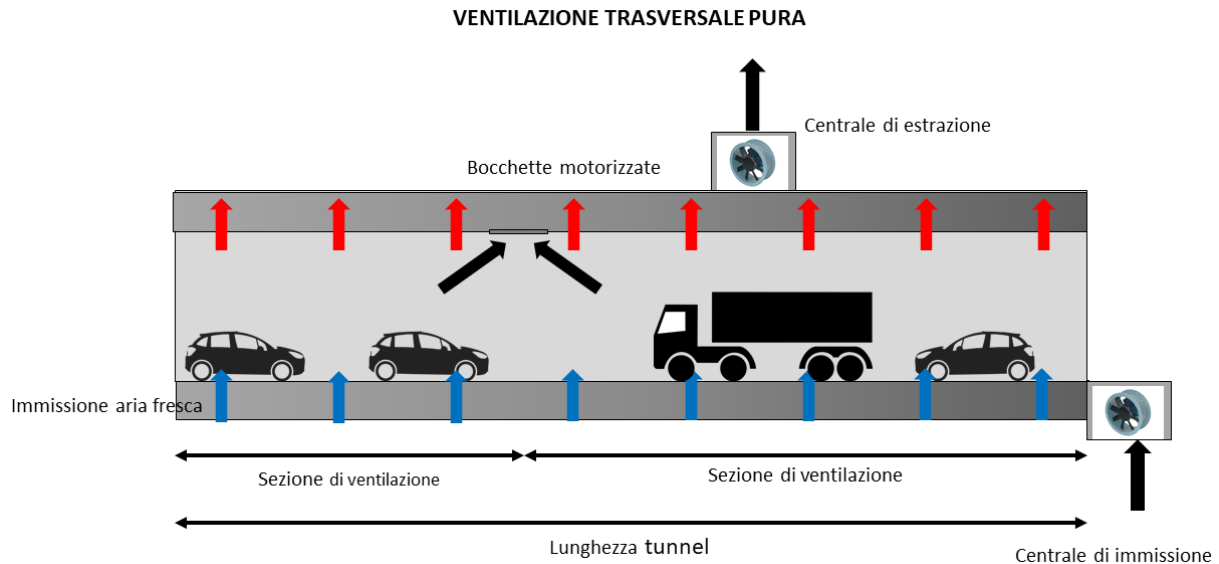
Schema di funzionamento della ventilazione trasversale.
